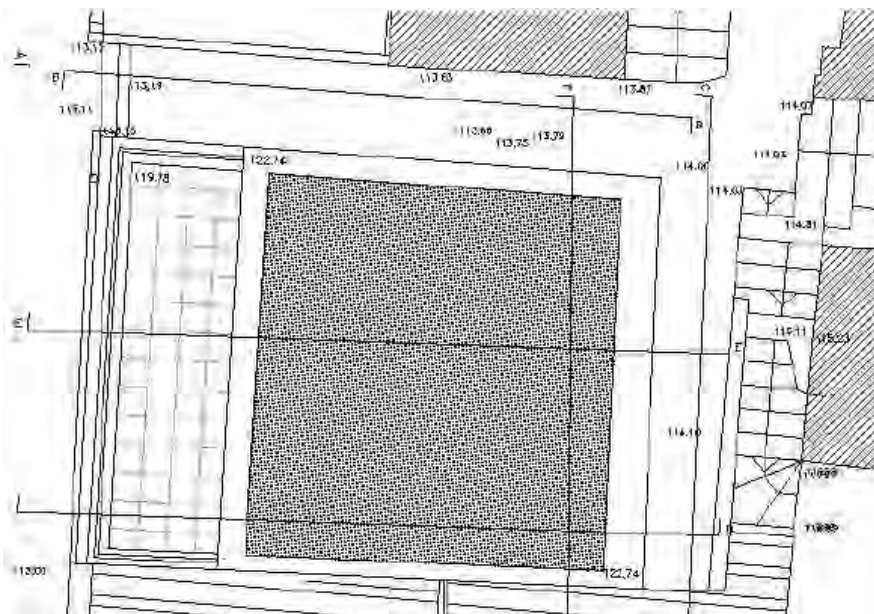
Planta do edifício Cedofeita: Cobertura
